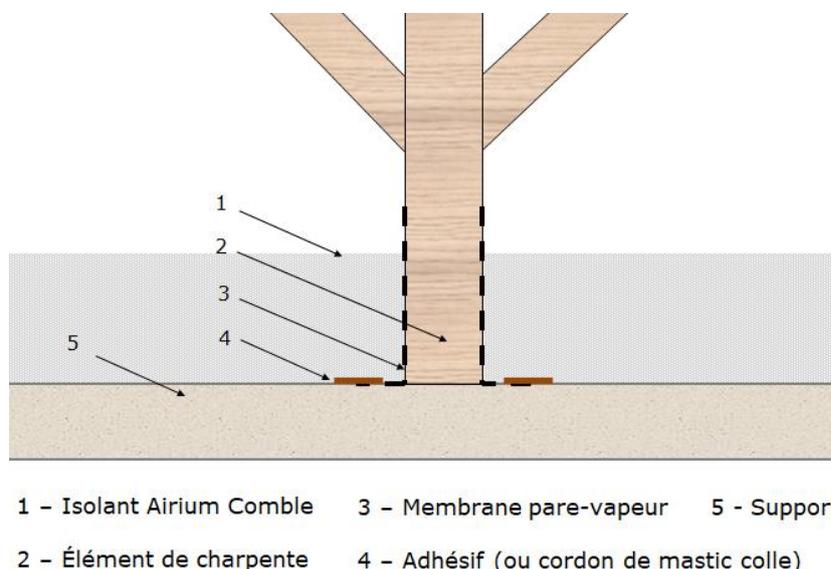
Exemple de mise en place d'un pare-vapeur au pied d'un poinçon de charpente partiellement noyé dans la mousse Airium® comble en zone très froide
